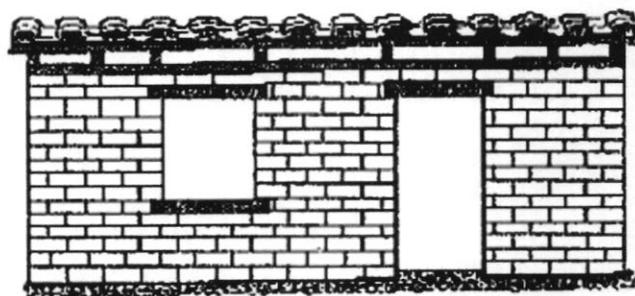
Distribución de cargas del techo sobre muro de adobe.
